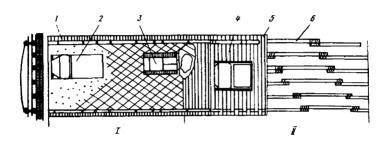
I. Схема устройства дерево-грунтовой одежди: І-устройство деревянного основания; П-устройство грунтового основания; І-прижимной брус; 2-автосамосвал; 3-бульдовер; 4-трелевочний трактор; 5-поперечний настил; 6-продольние пежни
